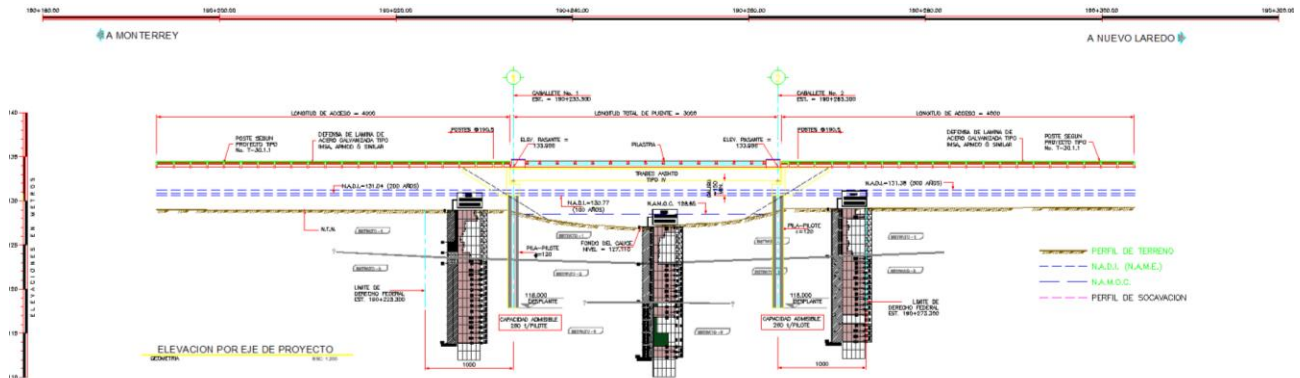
Plano de elevación del puente, se puede observar las pilas-pilotes que serán el soporte de la estructura.
